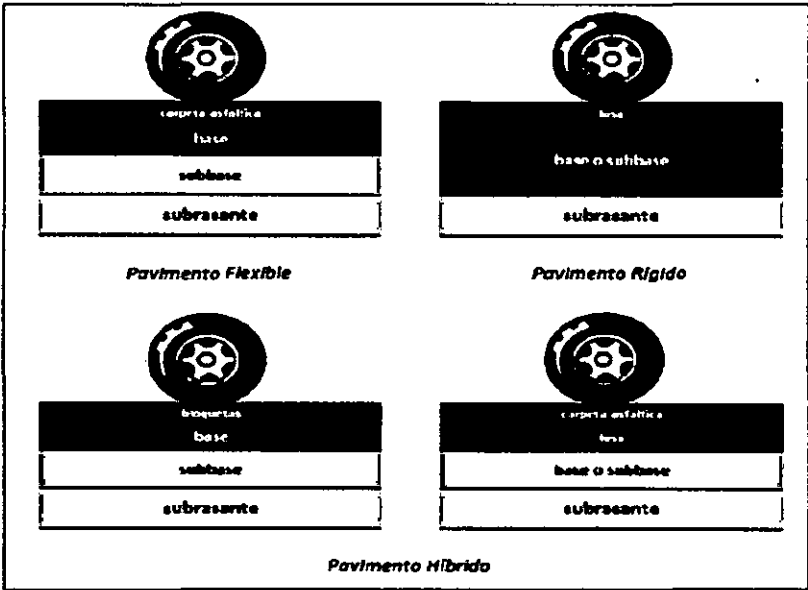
Esquema de Paquete Estructural para pavimentos flexibles, rígidos e híbridos.
